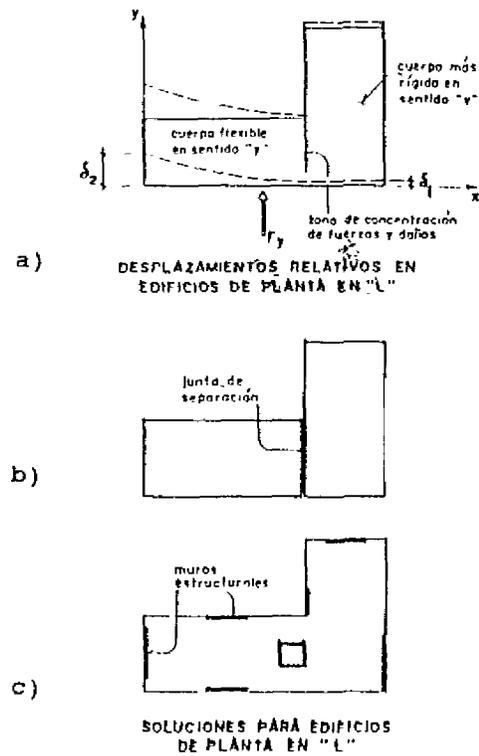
Soluciones a la asimetría de una a) planta en forma de "L", b) juntas de separación y c) muros estructurales para compensar asimetría en rigideces
